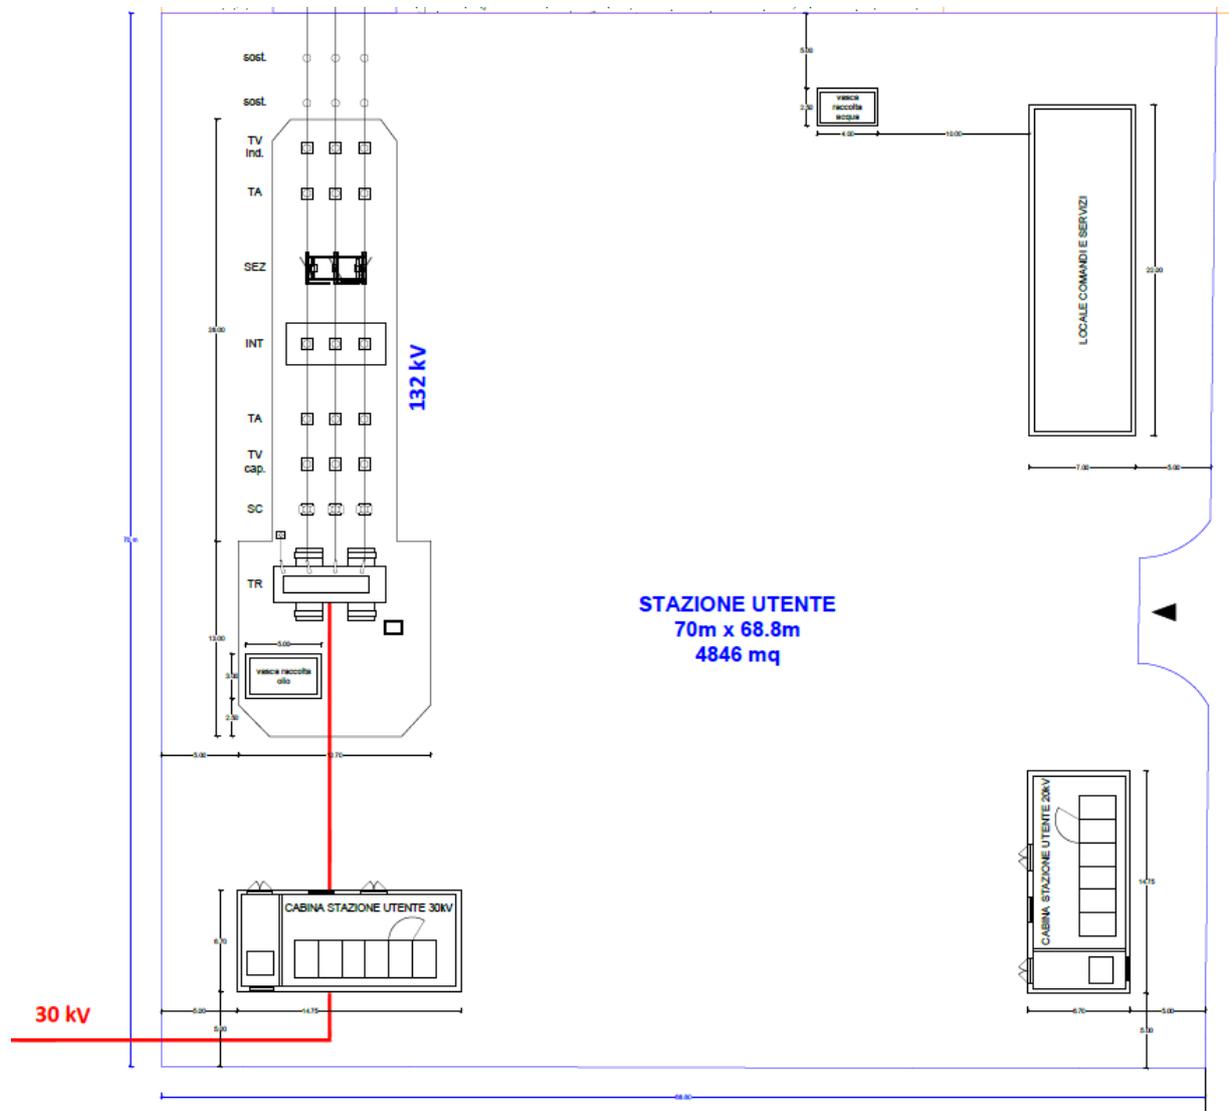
stralcio TAV 4.2_STAZ_Planimetria Generale Stazioni
